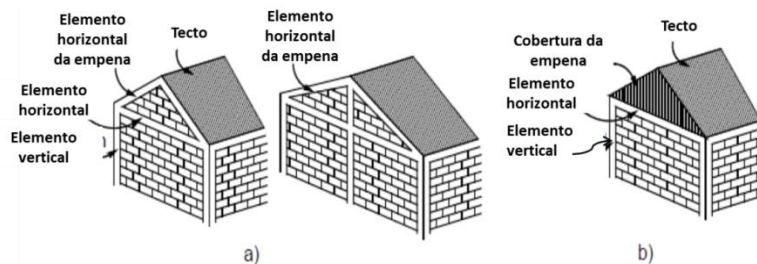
Frontões. a) Empena em alvenaria com viga. b) Empena com cobertura, sem alvenaria (Meli e Brzev (2011)).
